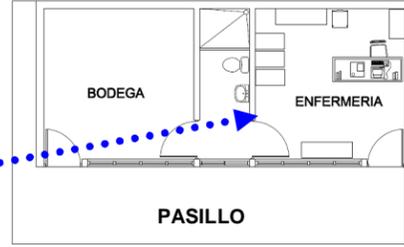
Edificio A, actualmente utilizado para enfermería y bodega./ Fuente: Propia
